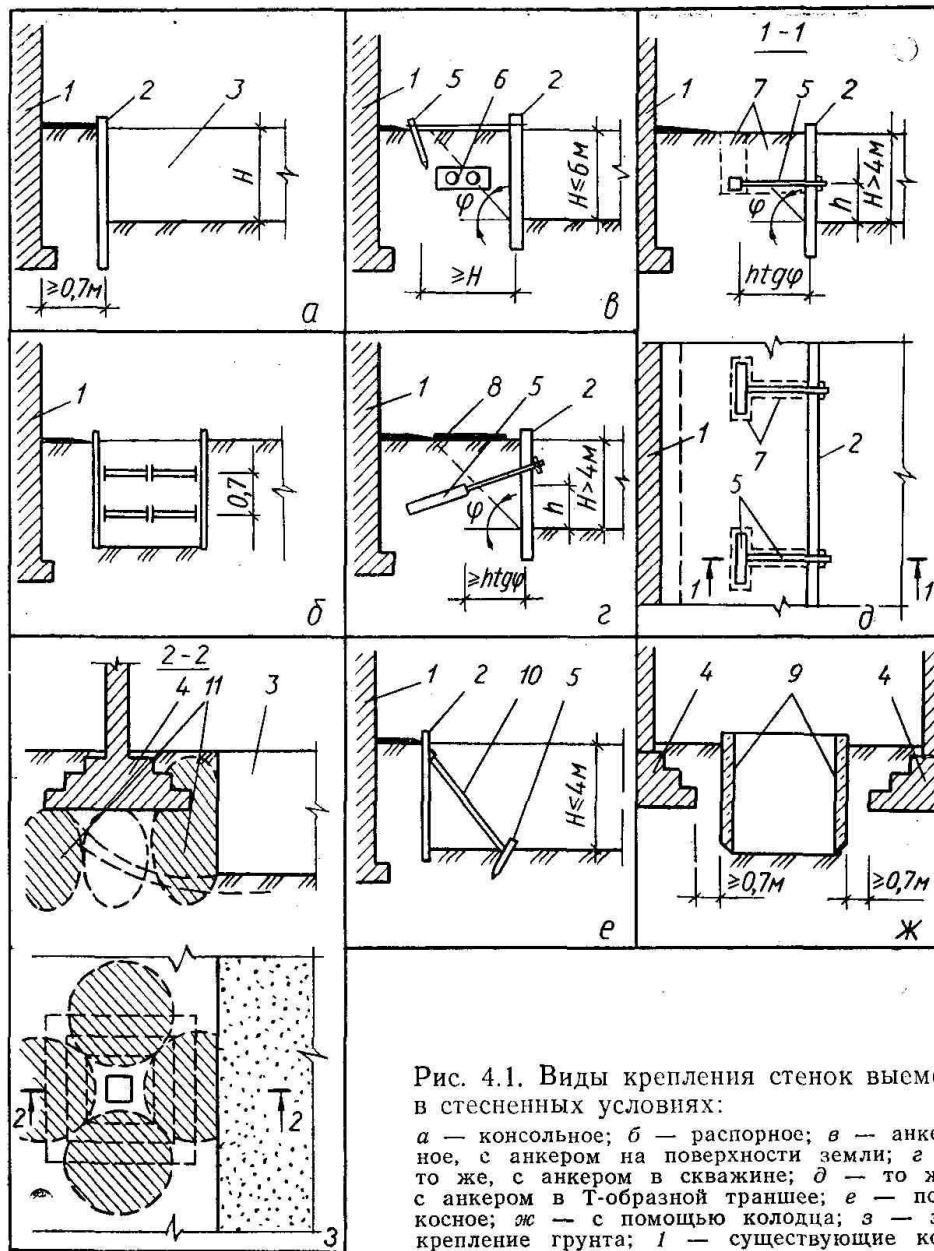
Виды крепления стенок выемок в стесненных условиях:
